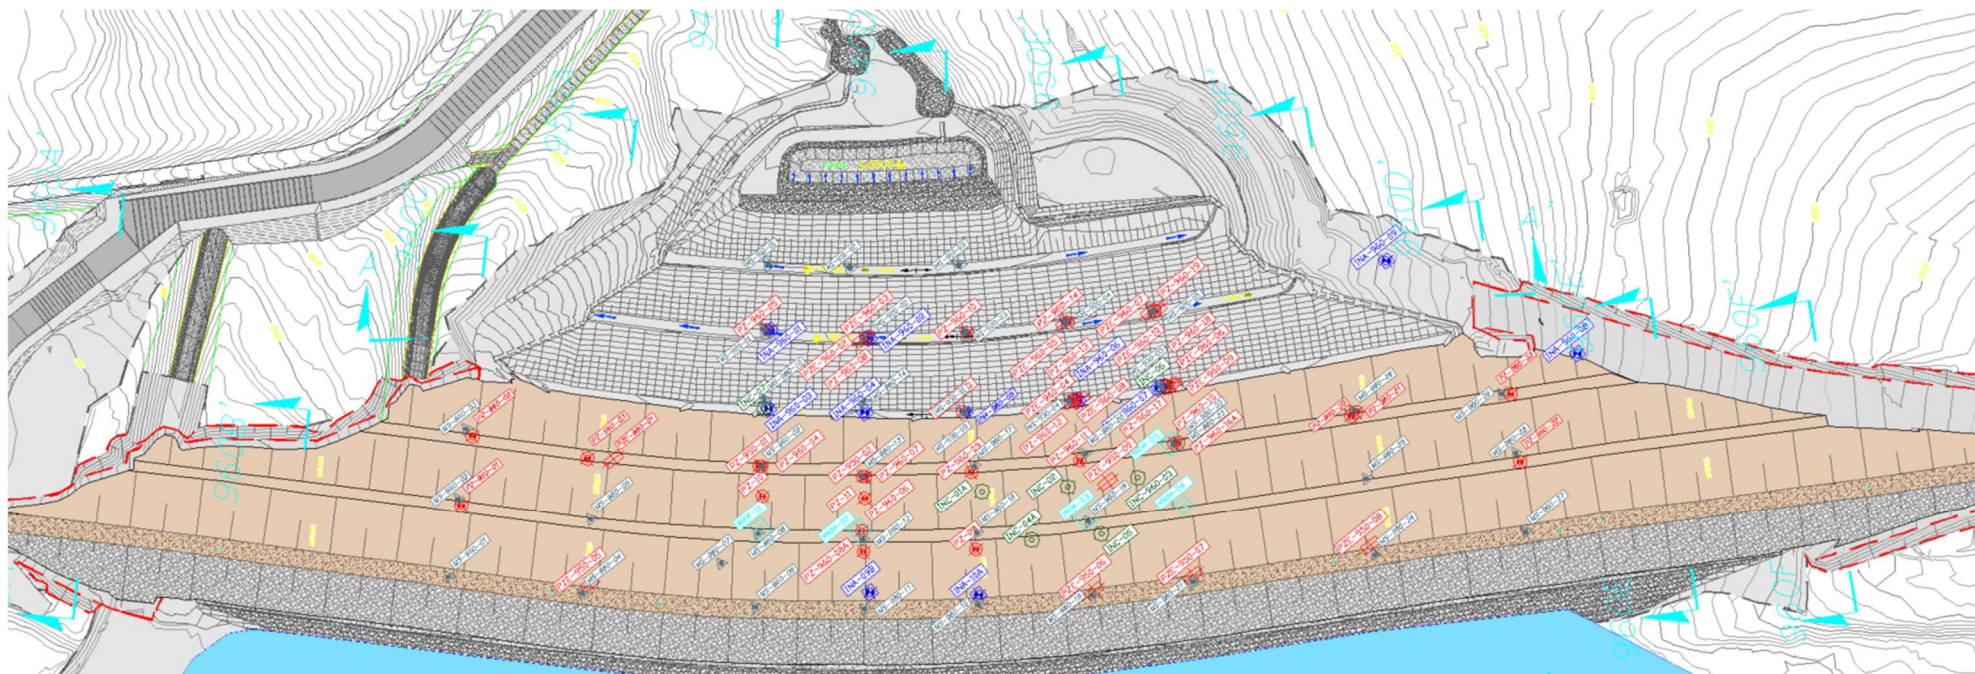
Planta de localização do Sistema de Monitoramento da Barragem Sabão I – Projeto Executivo do alteamento da El. 960 m.
